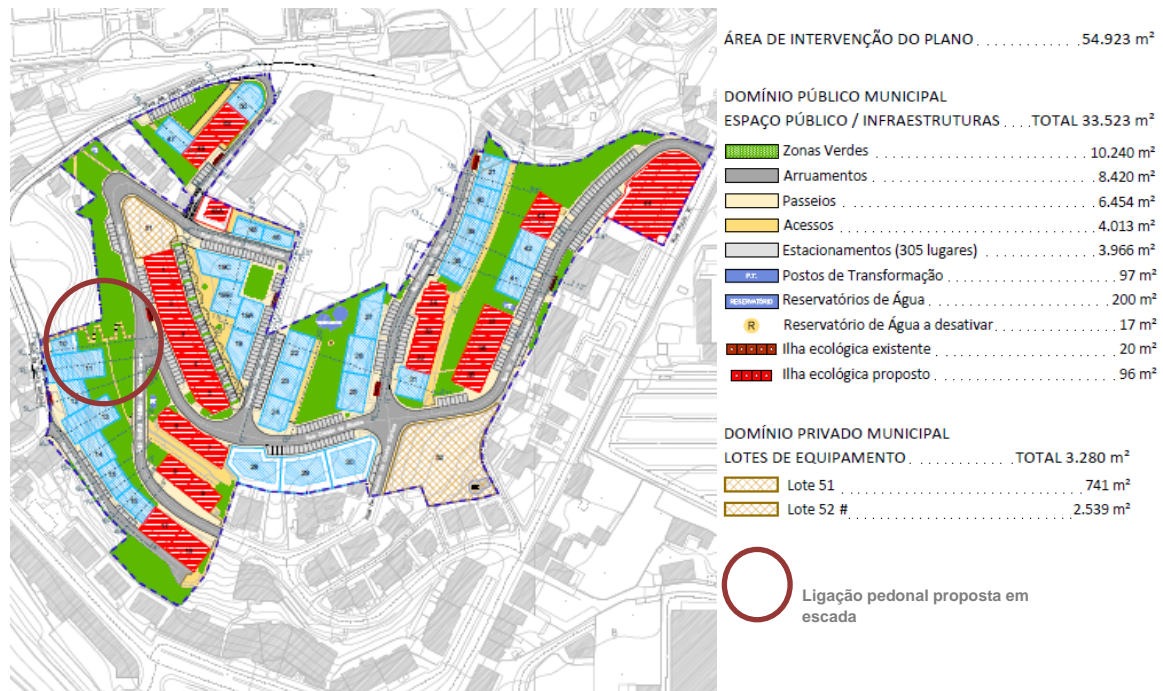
Extrato Planta de Implantação da proposta do PPVC
